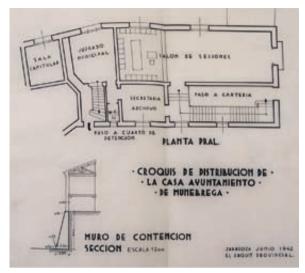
Planta y sección del proyecto de consolidación del ayuntamiento de Munébrega, 1942 (A.D.P.Z.).
